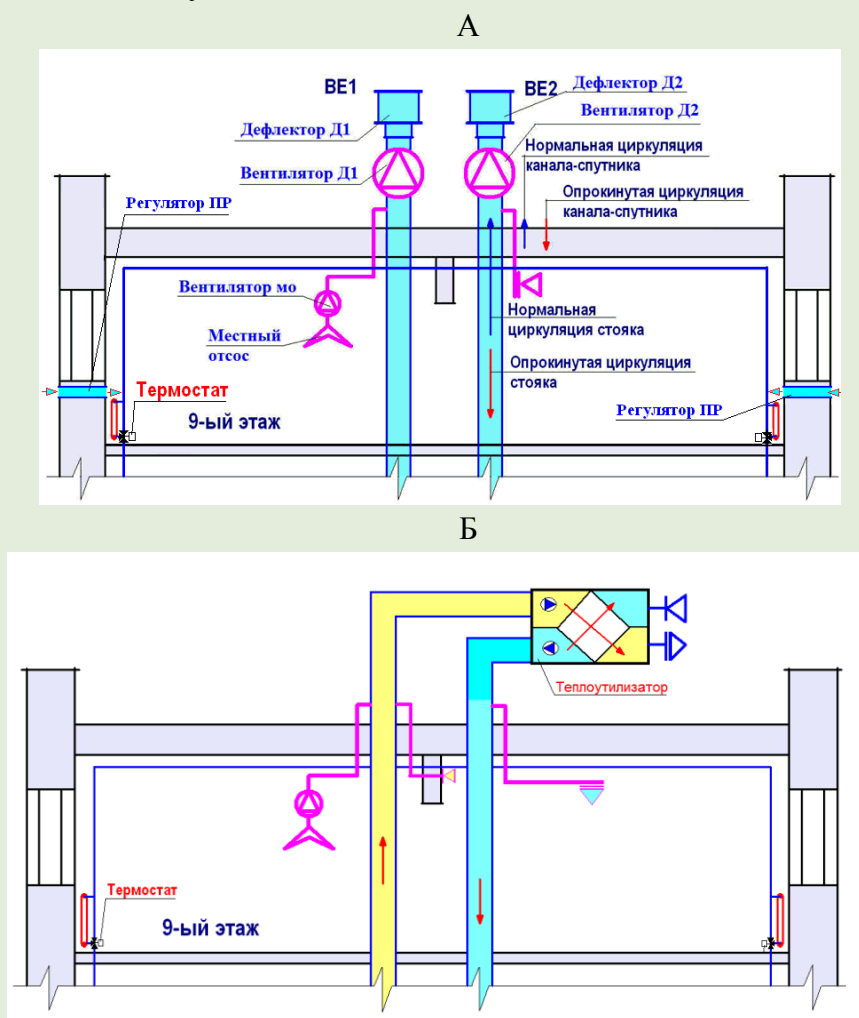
Схемы вентиляции и отопления жилого дома (показан только 9-ый этаж): А – естественный приток, Б - приточно-вытяжная механическая вентиляция с утилизацией теплоты.
